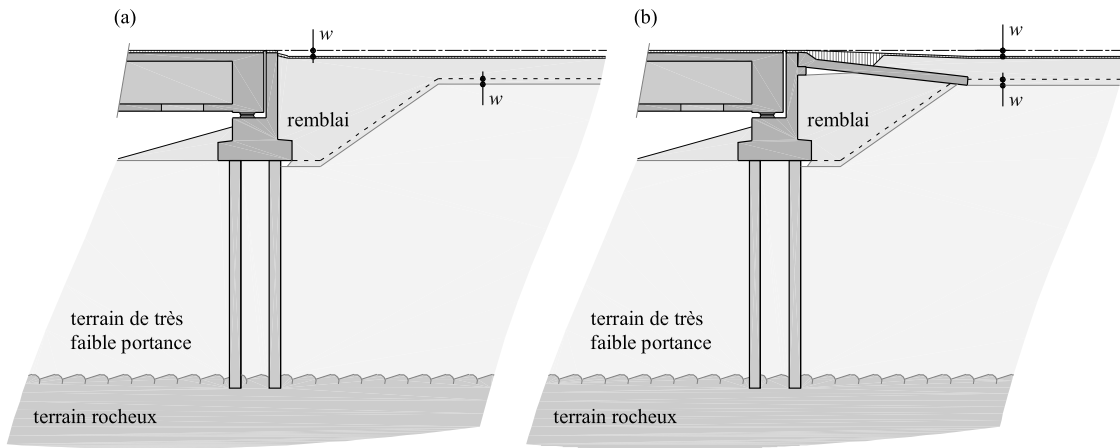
Tassement local de la surface de roulement à l'extrémité d'un pont fondé sur des pieux profonds traversant une couche de terrain de très faible portance ; (a) cas sans dalle de transition ; (b) cas où une dalle de transition est présente
